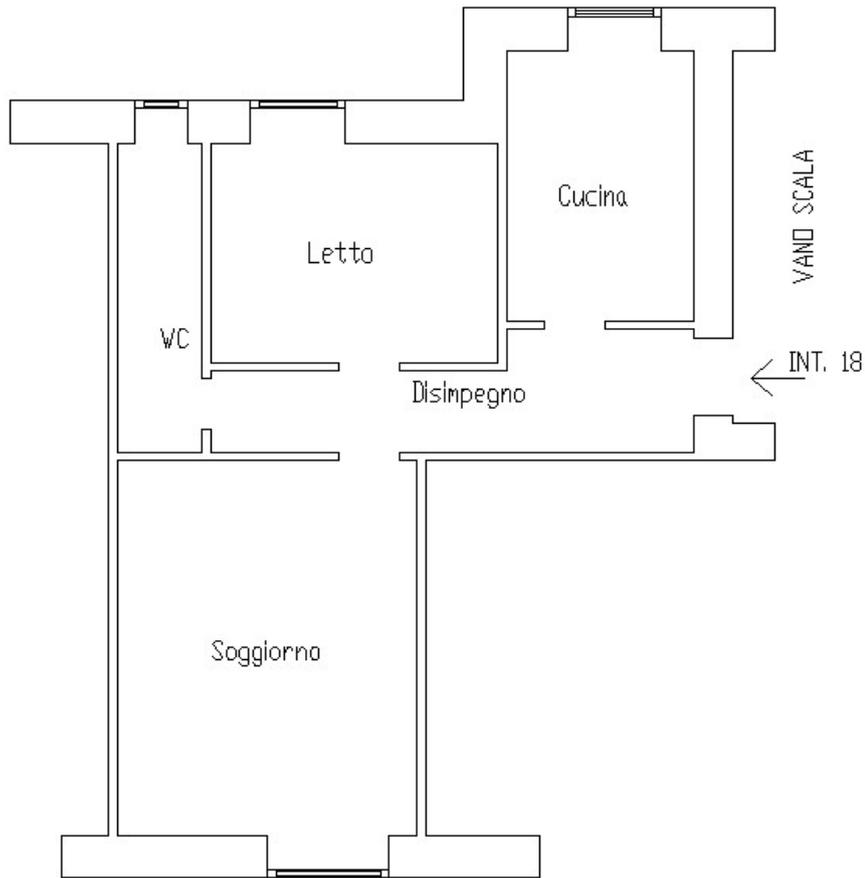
Planimetria dell'appartamento oggetto di pignoramento- interno 18
